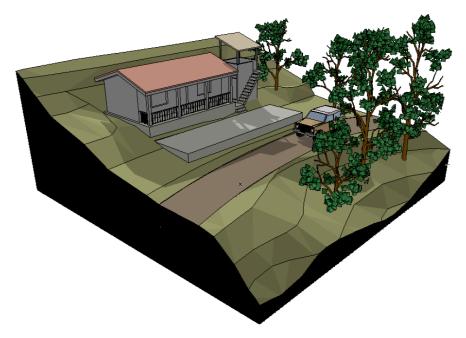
Vivienda rural minifundista al lado de la vía donde asciende el terreno Fuente: Elaboración propia
